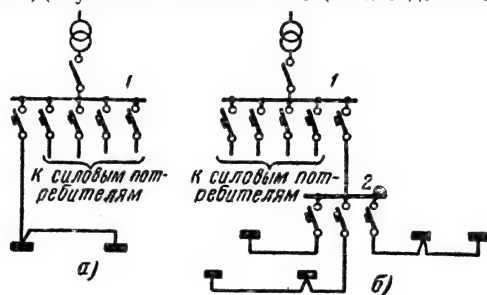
Схема питания рабочего освещения от щита подстанции.
